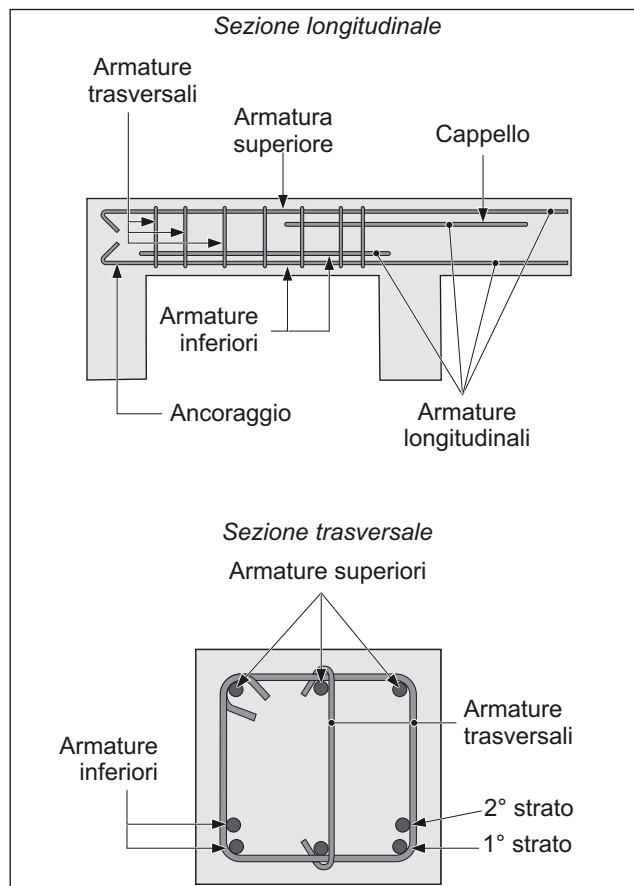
Posizionamento delle diverse armature in una trave.
